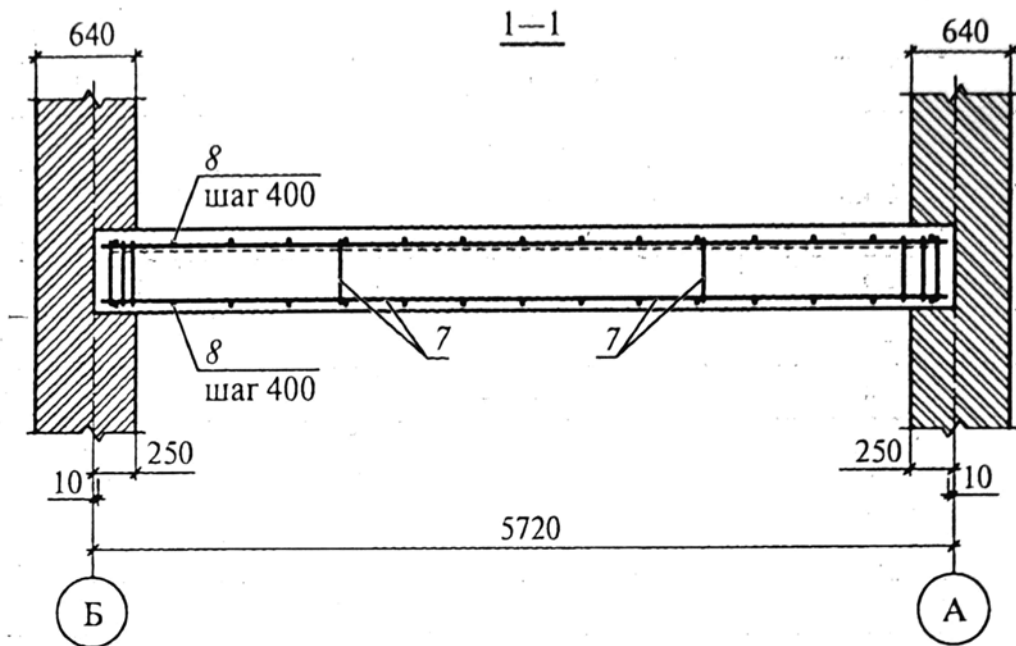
Раздельное армирование балочной плиты плоскими сетками с поперечной рабочей арматурой:
